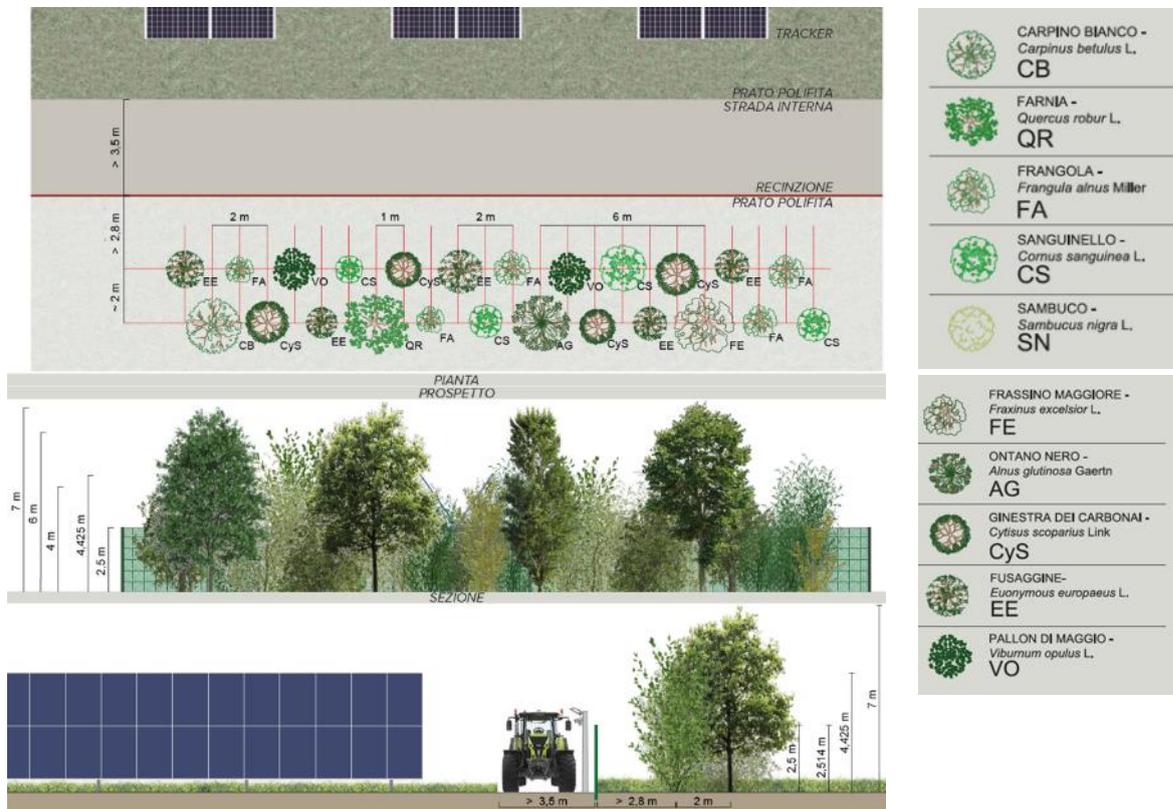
Il sesto d'impianto delle fasce di mitigazione a doppio filare di Tipo 2
